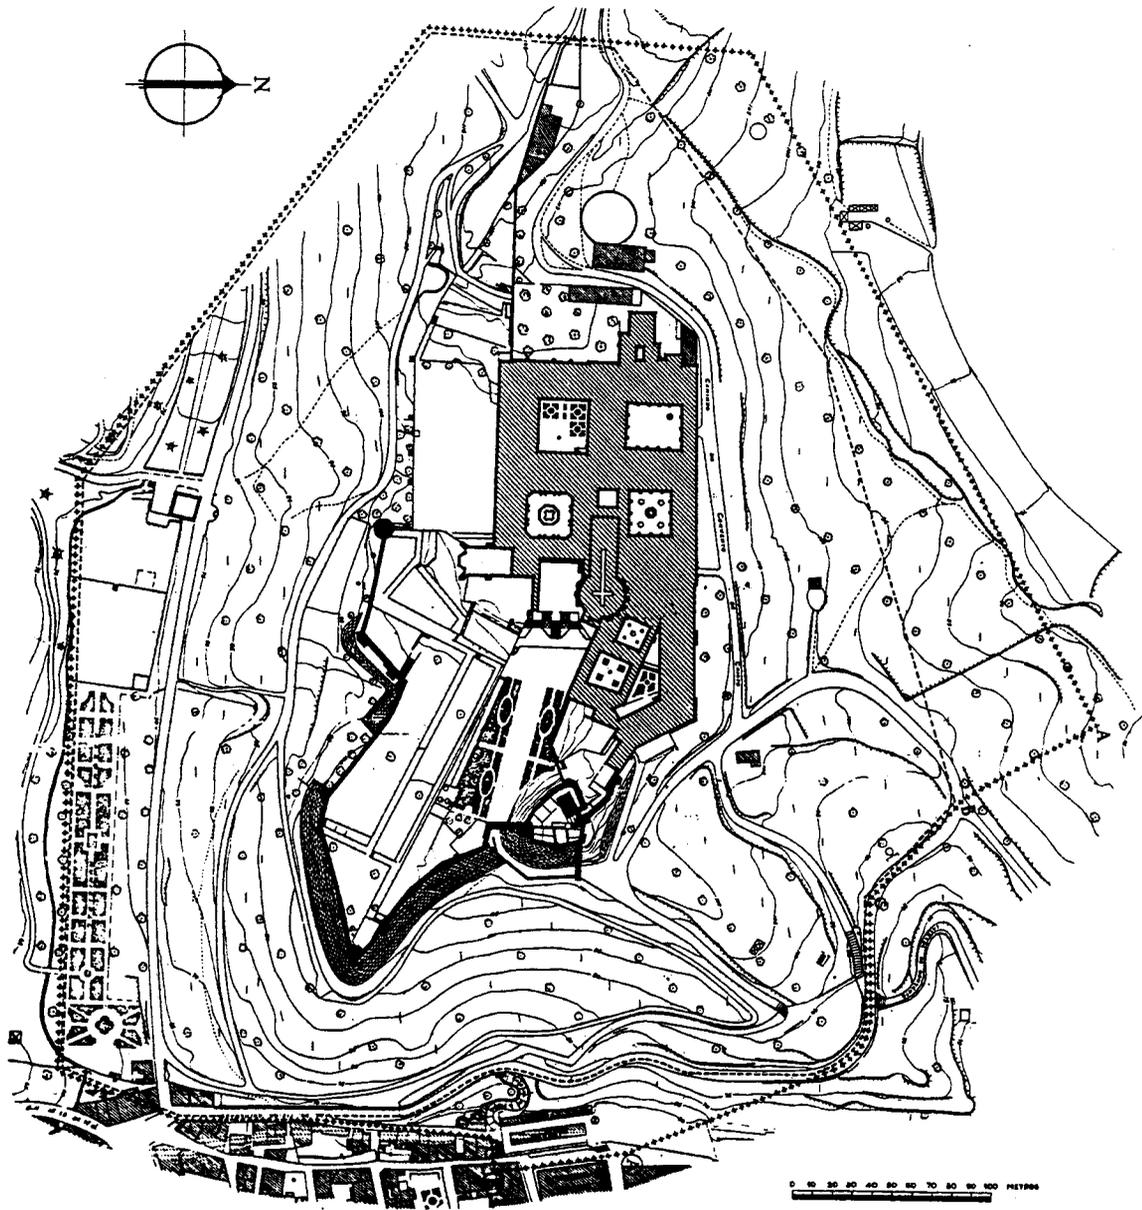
Tomar – planta actual do Castelo (planta da D.G.E.M.N.)
